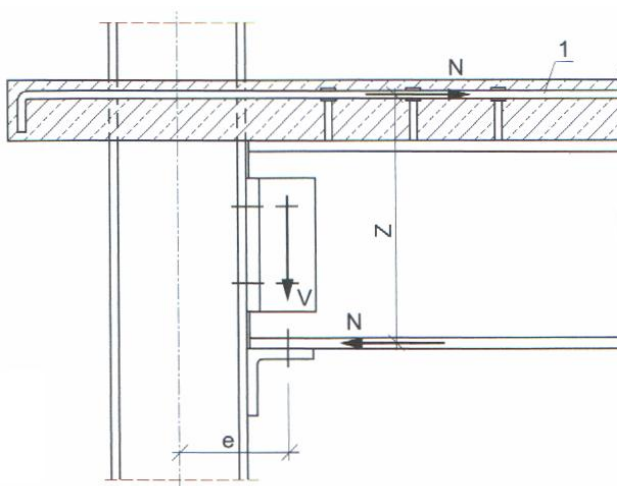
Конструктивное решение узлового соединения сталежелезобетонной балки с колонной
